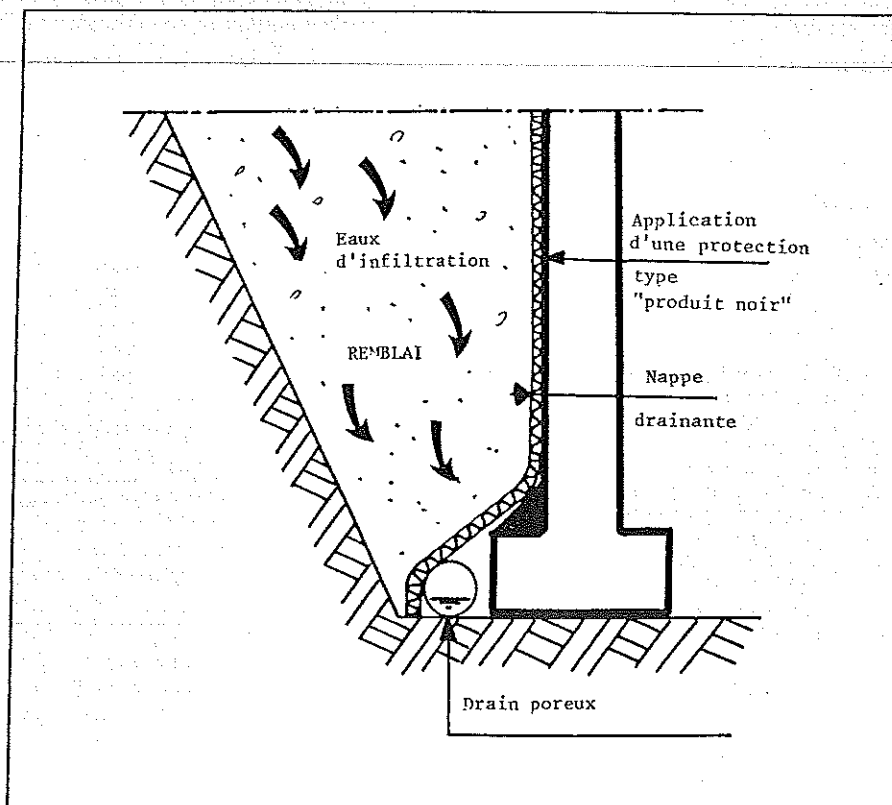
Protection des murs de soubassement contre les infiltrations d'eaux par l'interposition d'une nappe drainante
